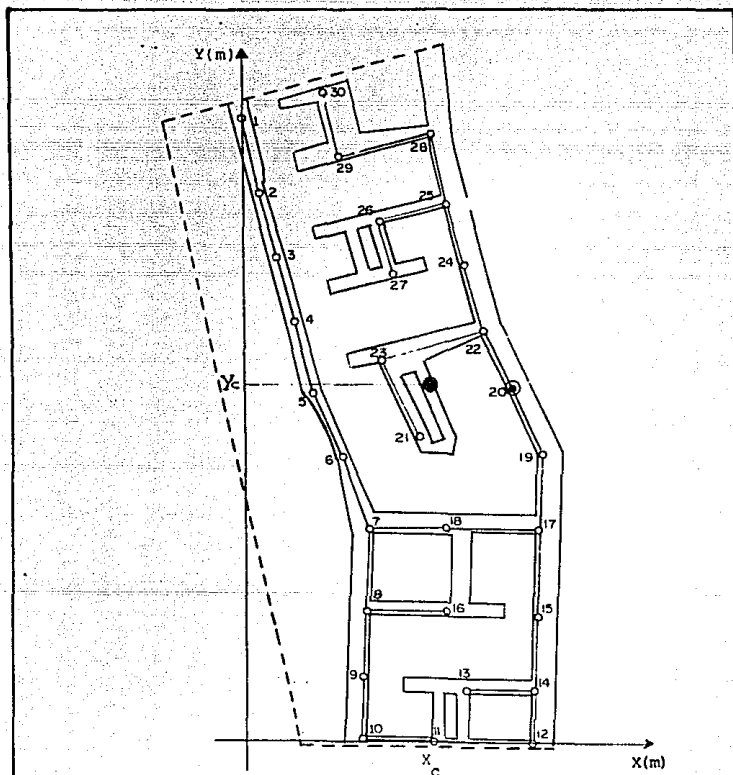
AREA No. 2 DEL PLANO TP-4-2.
